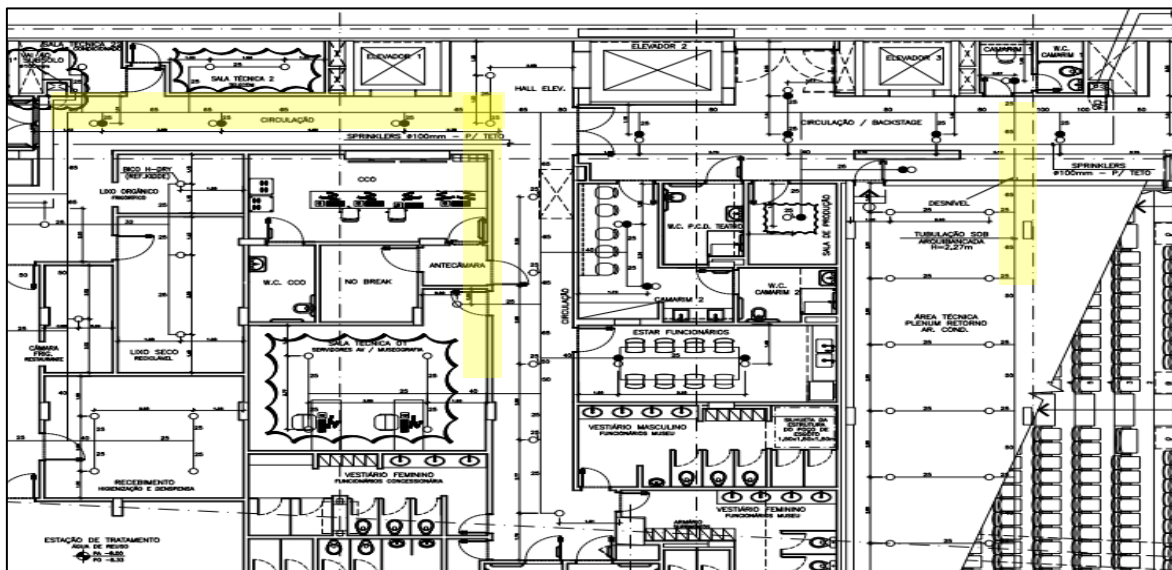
Demonstração da Patologia da Tubulação de aço galvanizado de 65 mm – 2º Pavimento
